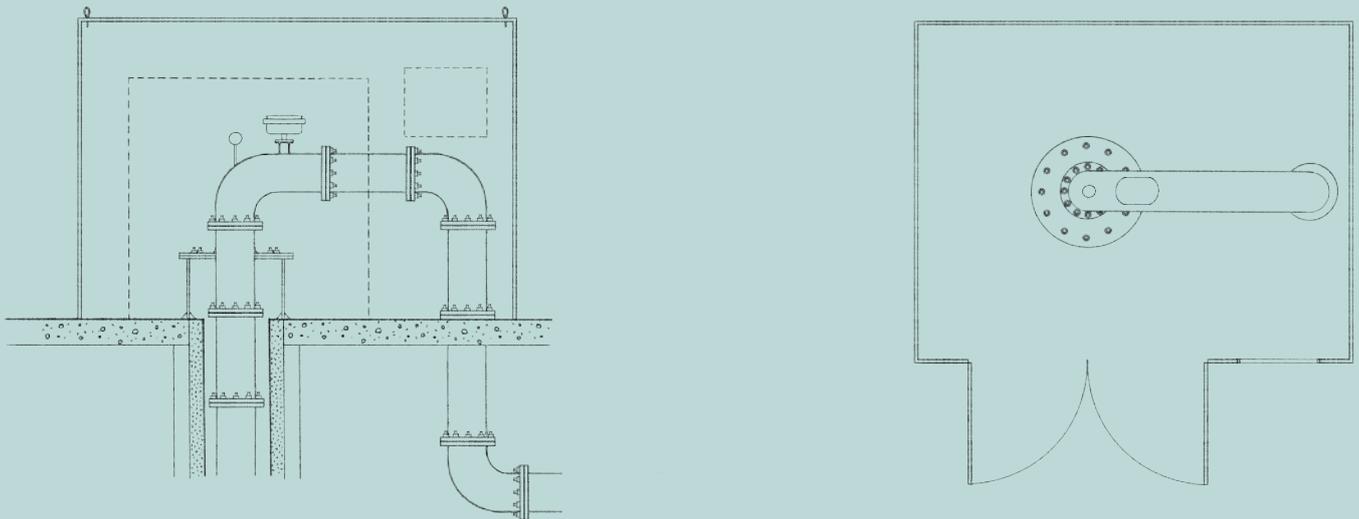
Vista en planta y perfil del sello sanitario o losa de hormigón de un pozo alojado en el interior de una caseta metálica retirable. En este caso, el sello sanitario se extiende para cumplir, también, como solera de la caseta. La caseta metálica móvil, unida con pernos a la losa de hormigón o sello sanitario del pozo, dispone de unas argollas en el techo para su retirada con grúa durante las operaciones de mantenimiento que lo requieran.
